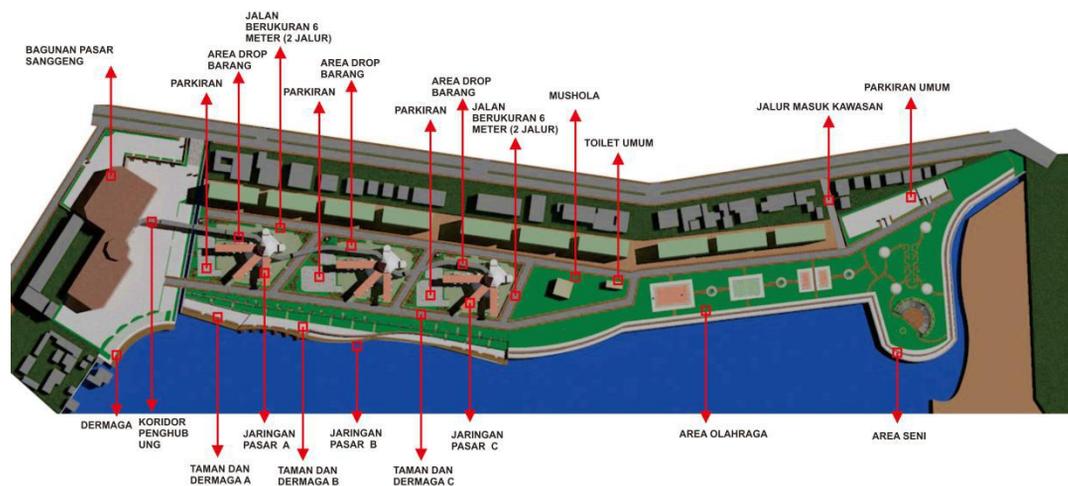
Rencana Tapak Bangunan (Siteplan)
